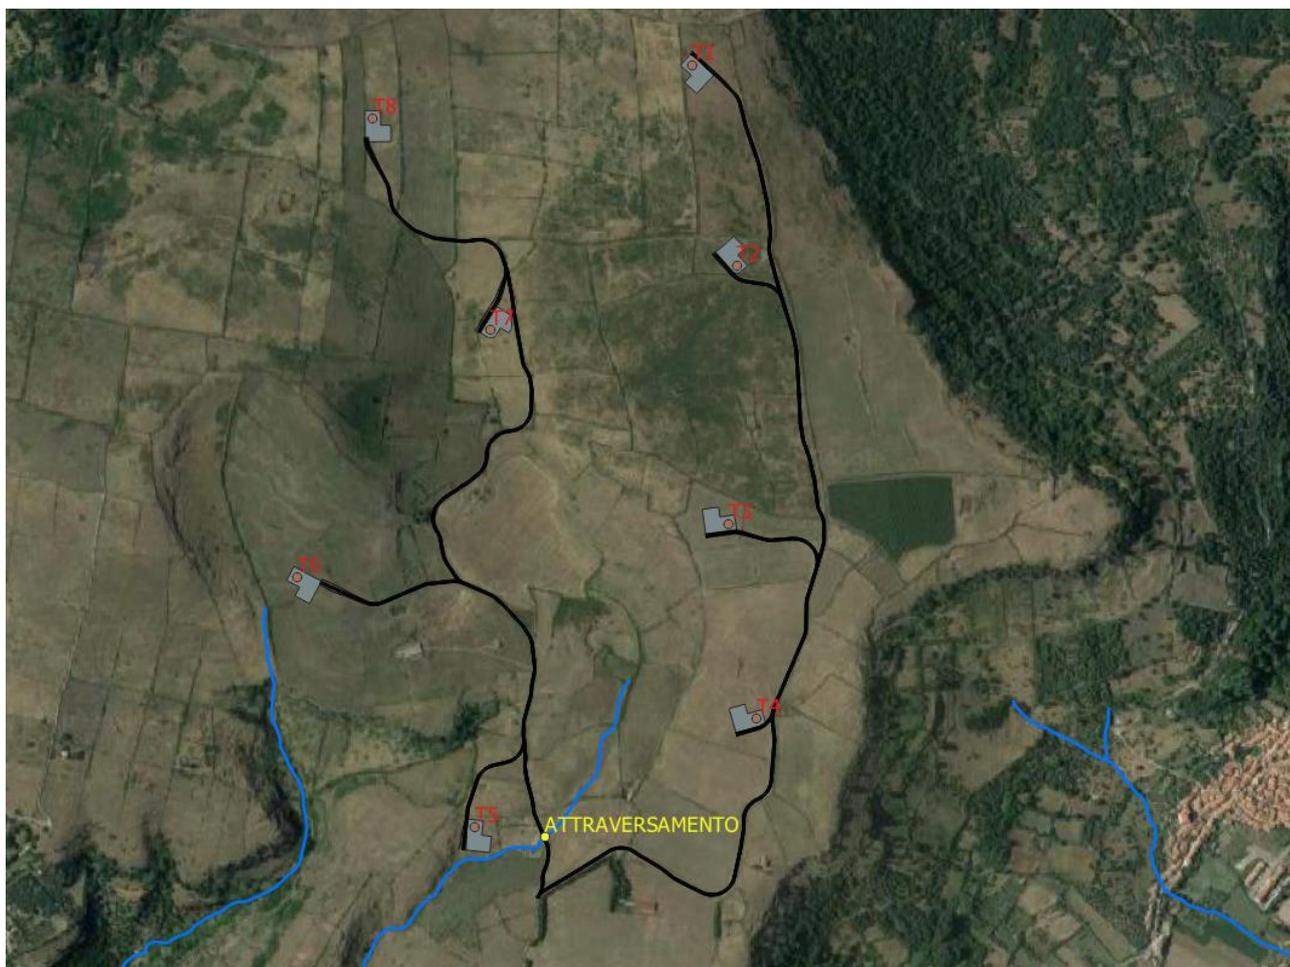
Planimetria con individuazione dell'attraversamento idrico
